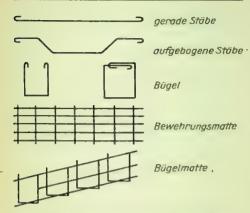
Grundformen von Bewehrungsstäben
